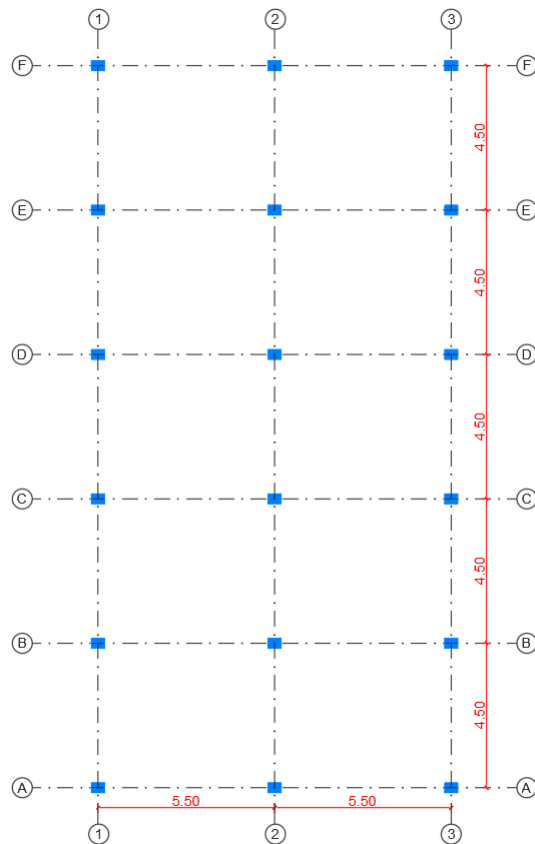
Distribución Arquitectónica Garaje Planta Baja.
